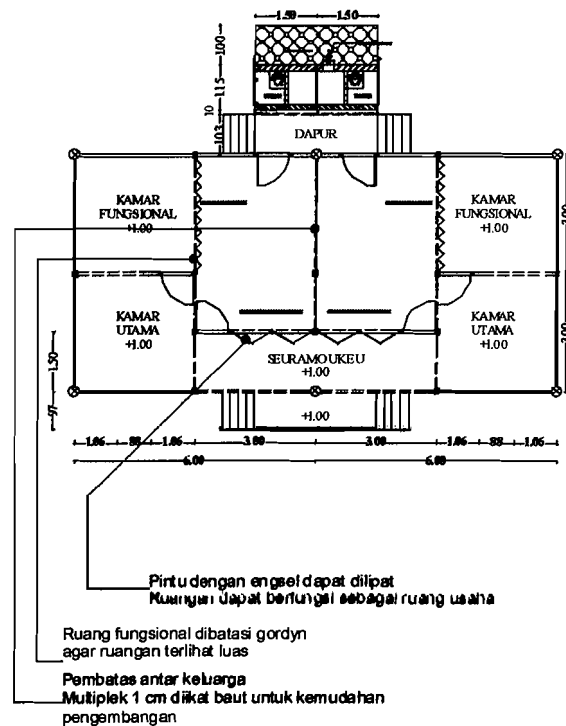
Denah Barak dan Ruang Usaha LT 1
